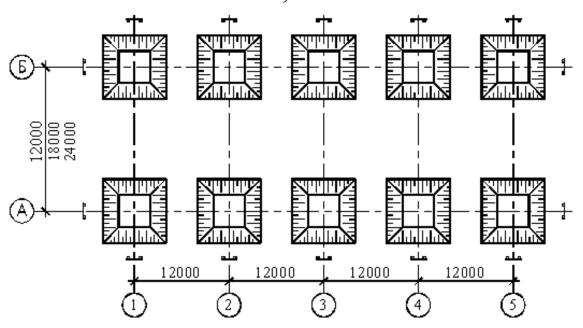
Схема устройства котлованов при шаге и пролете колонн 12 м и более
